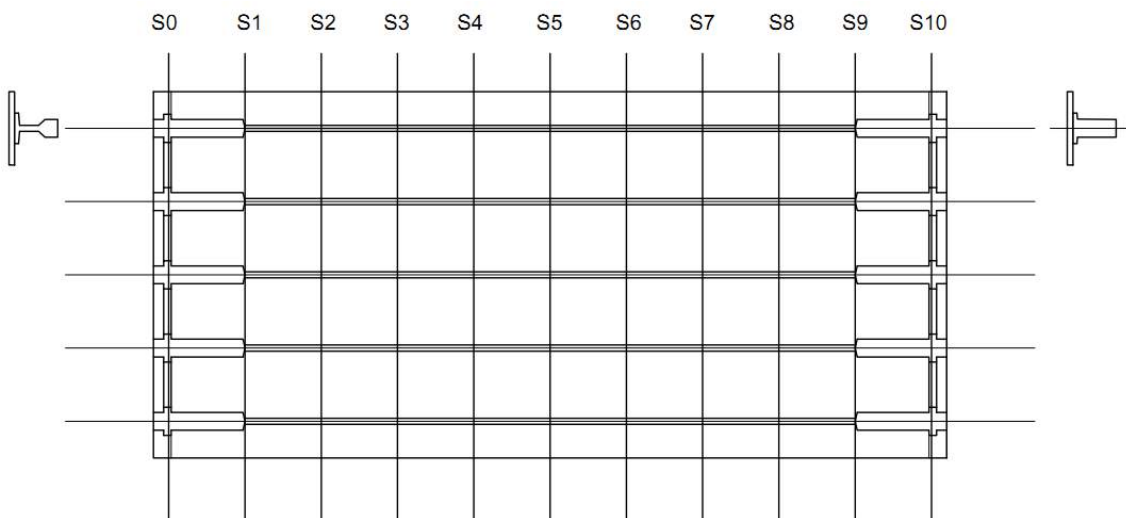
Vista em planta de um vão do viaduto. Fonte: DIAZ (2016), adaptado.
